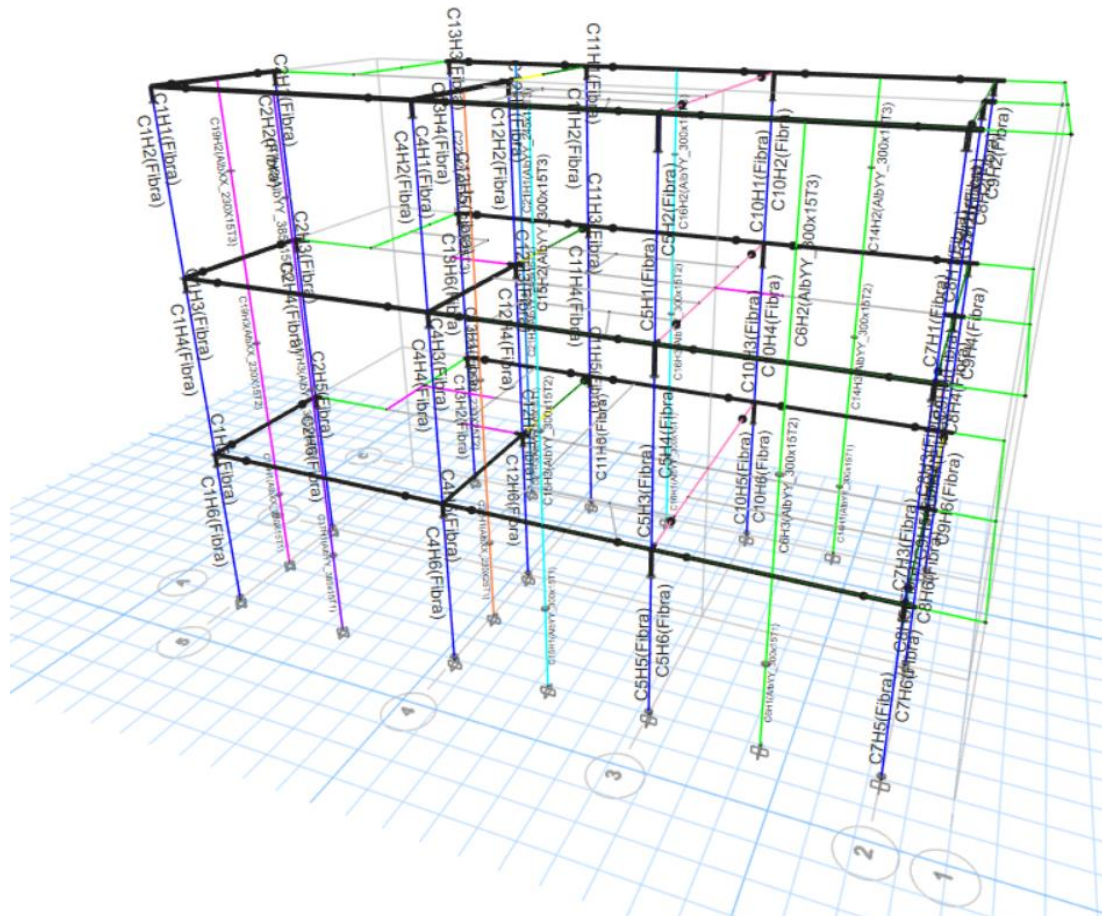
Modelado de vigas, columnas y muros de albañilería (Fuente: propia)
